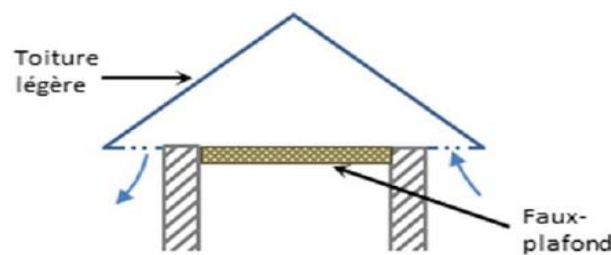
4 : Installation d'un faux-plafond sous une toiture légère (ECONOLER, 2011)
